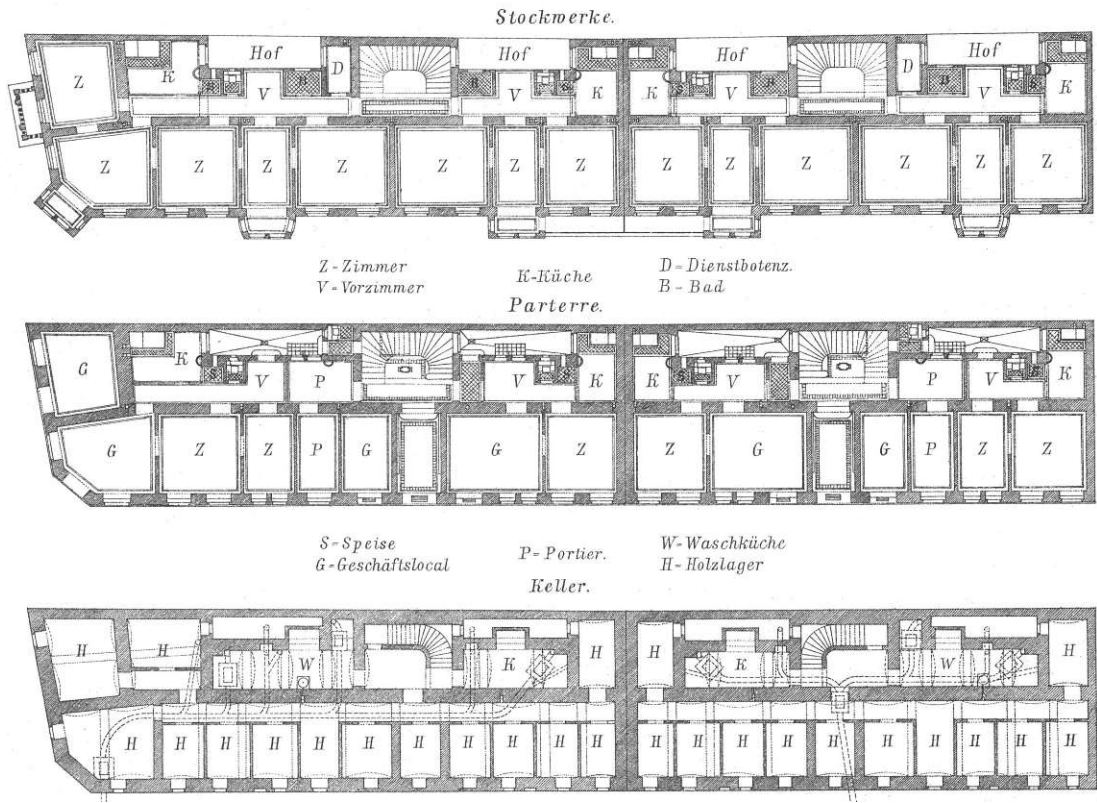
Grundrisse Doppelwohnhaus des Herrn Ignaz Frank, Heugasse 26 - Friedrich Schön, 1888
